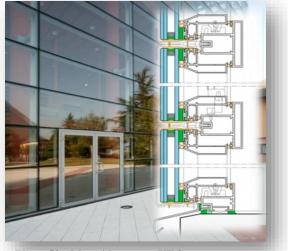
Mur rideau type VEC. Source: https://www.installuxaluminium.com/professionnel/notre-offrebatiment/facade/toutes-les-facades/lesgammes/univers-vec-th.
